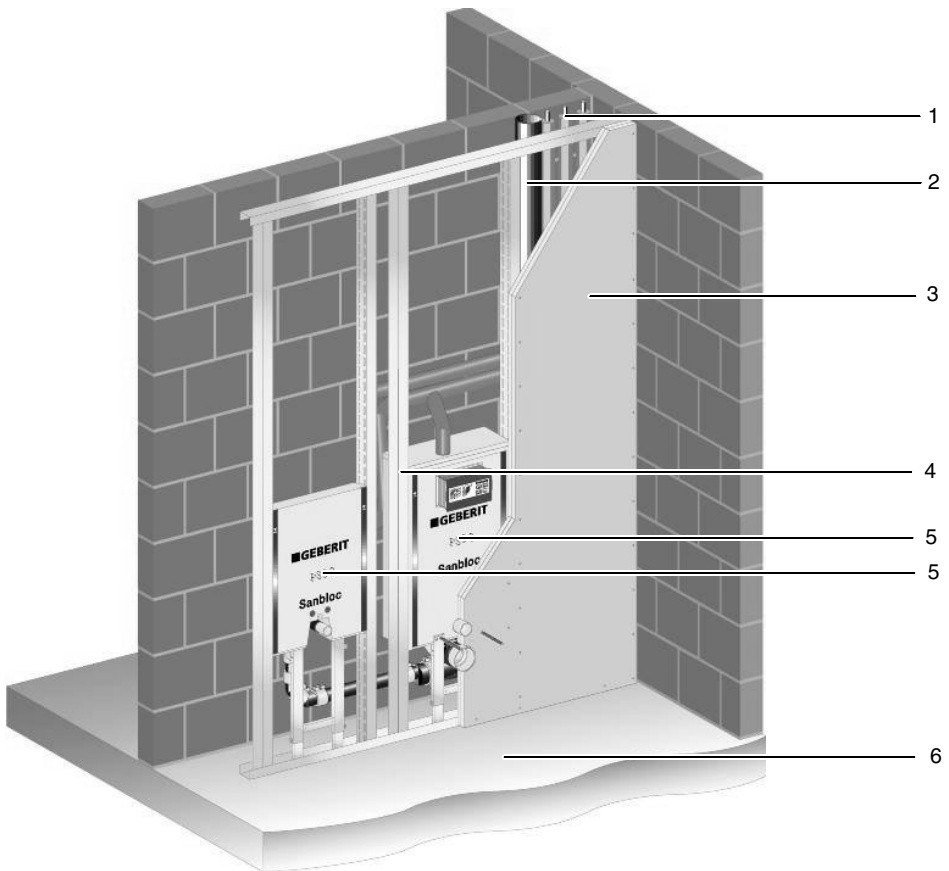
Geberit Sanbloc Installationsbaustein FS 90. Für den universellen Einbau in Schacht- oder Trennwände im Nass- und Trockenbau. Abgebildet ist die Einbausituation Trockenbau.
